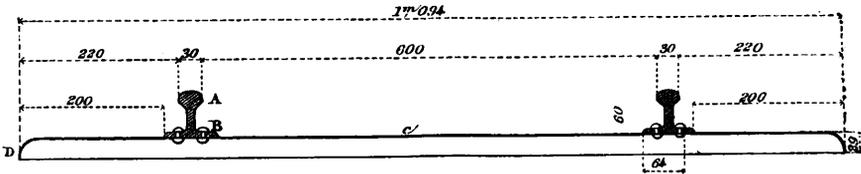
Profil de la voie de 0^m,60 en rail de 9^k,500.
